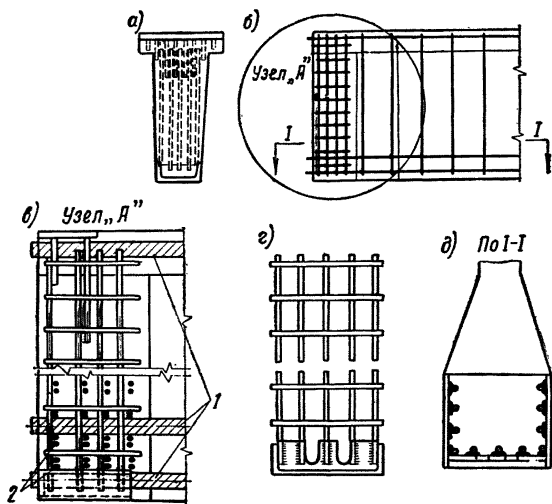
Усиление торца изгибаемого предварительно напряженного элемента со стержневой арматурой из горячекатаной стали
